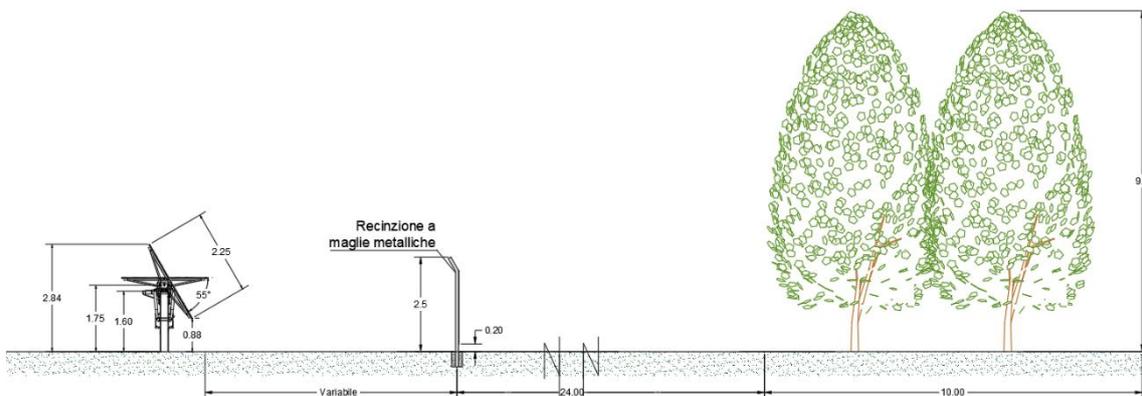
Schematizzazione della mitigazione a verde – Fascia da 10 metri e altezza 9 metri
